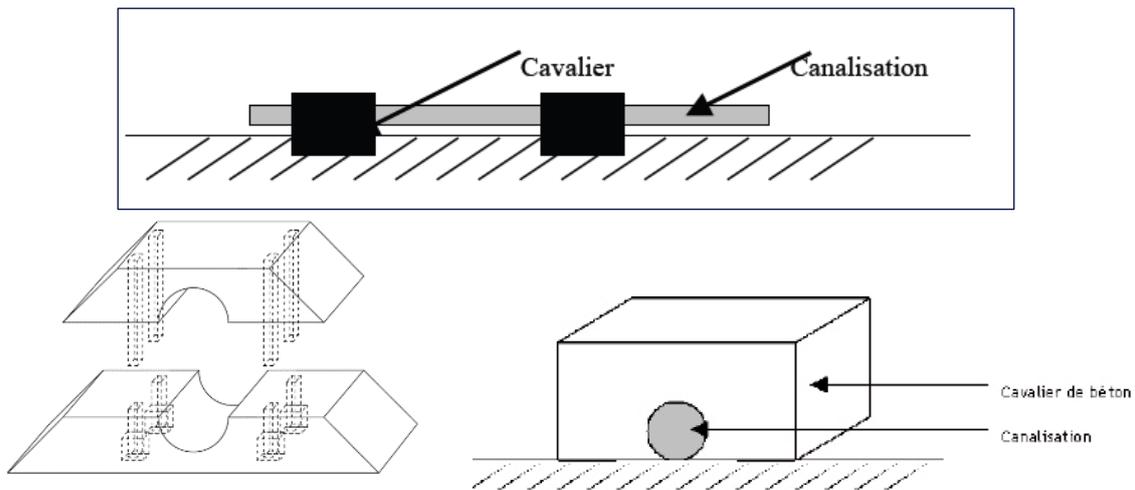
Représentation schématique d'une conduite lestée avec des cavaliers béton
